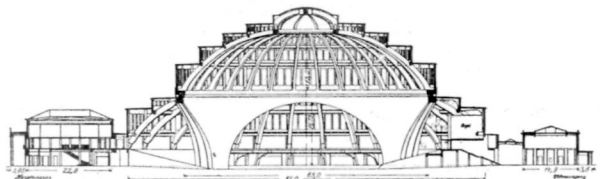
Jahrhunderthalle zu Breslau. Längsschnitt
